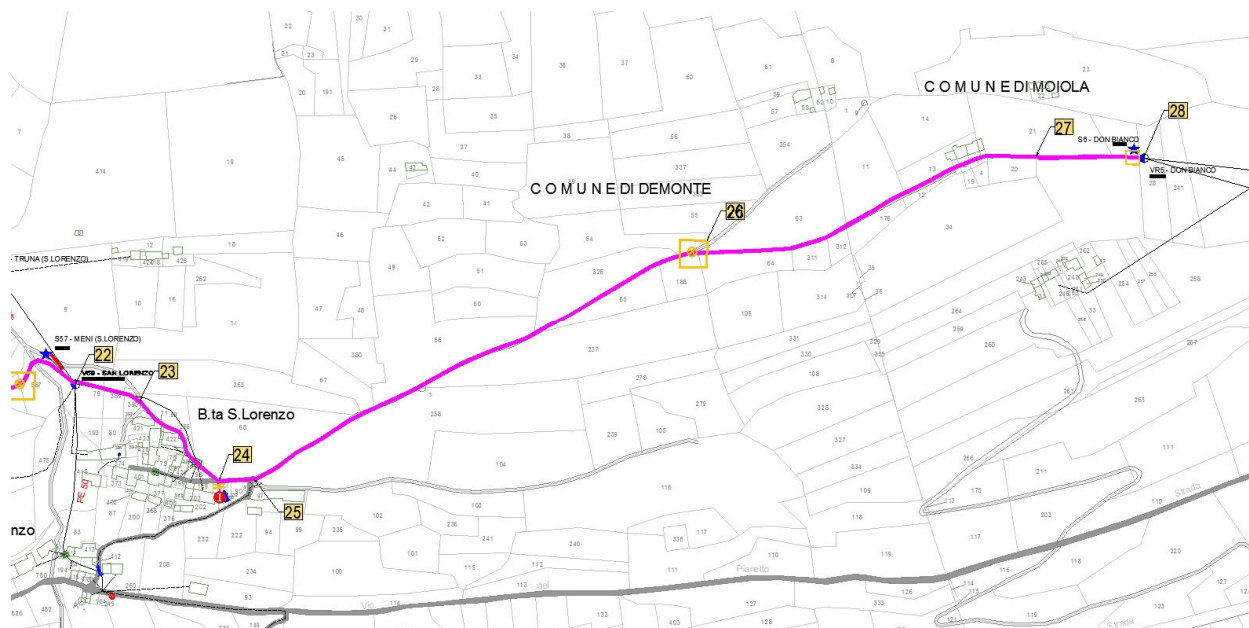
nuova condotta a progetto tra la Sezione 22 e la Sezione 28 su stralcio planimetria catastale.
